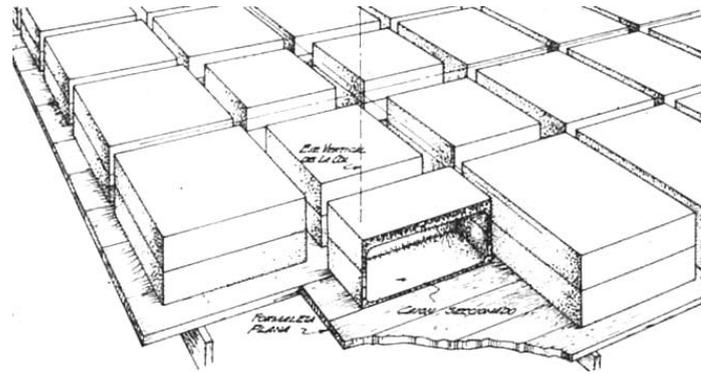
Imagen B esta página. Planta y sección de la placa de entrespaño Banco Central Hipotecario, Bogotá.
